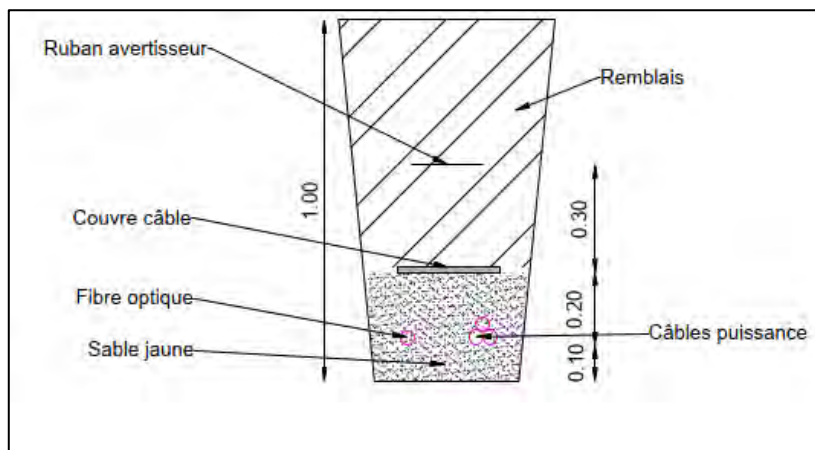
Coupe de principe d'une tranchée pour le câblage électrique (source : Plans de la demande de permis, 2026).
